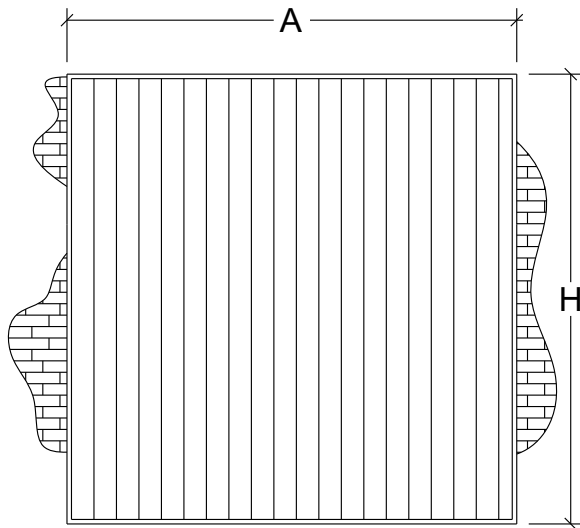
Detalle de alzado de puerta industrial corredera apoyada
